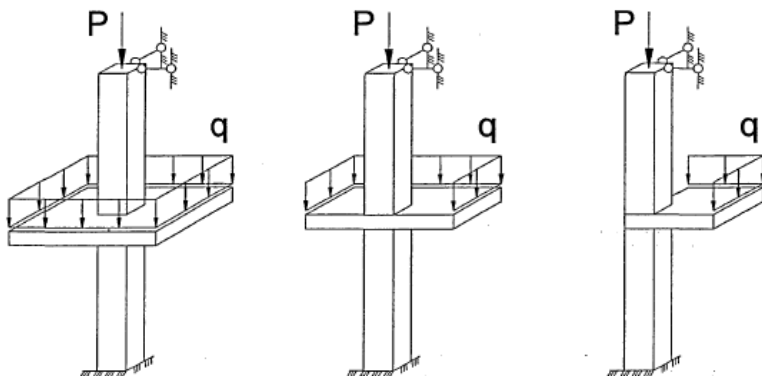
Расчетные схемы моделей узлов перекрытия с колоннами
